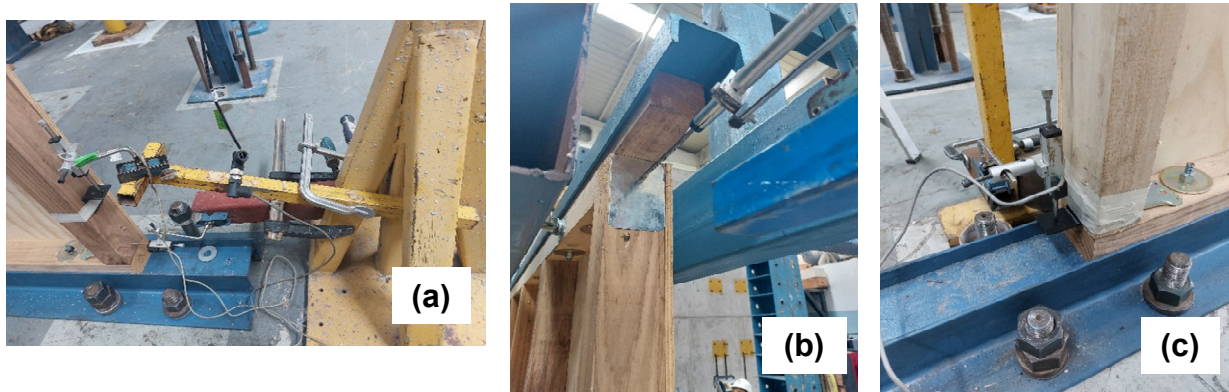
Anclaje de viga de carga a muro con HBS6140 para MURO1 (a) y barra roscada 1/2" para MURO 2 y 3 (b)
